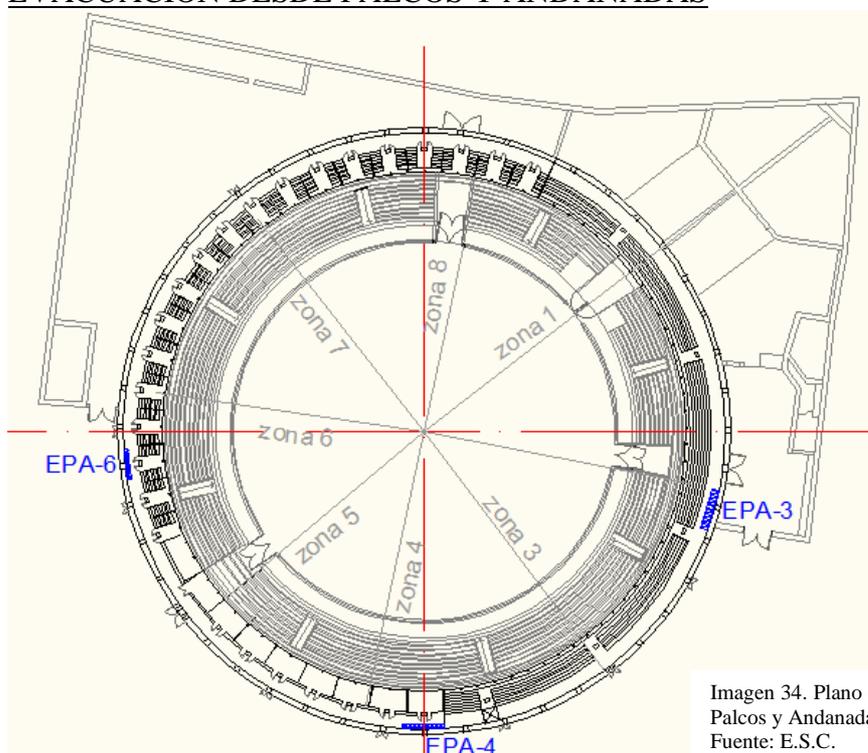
Plano con escaleras de evacuación de Palcos y Andanadas.
